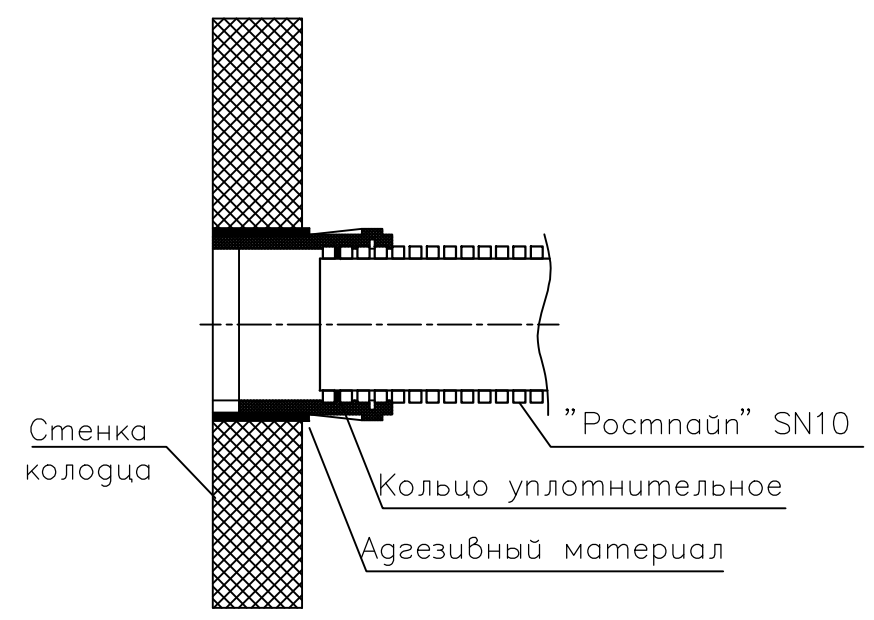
Схема соединения труб с бетонным колодцем при помощи соединительной муфты.
